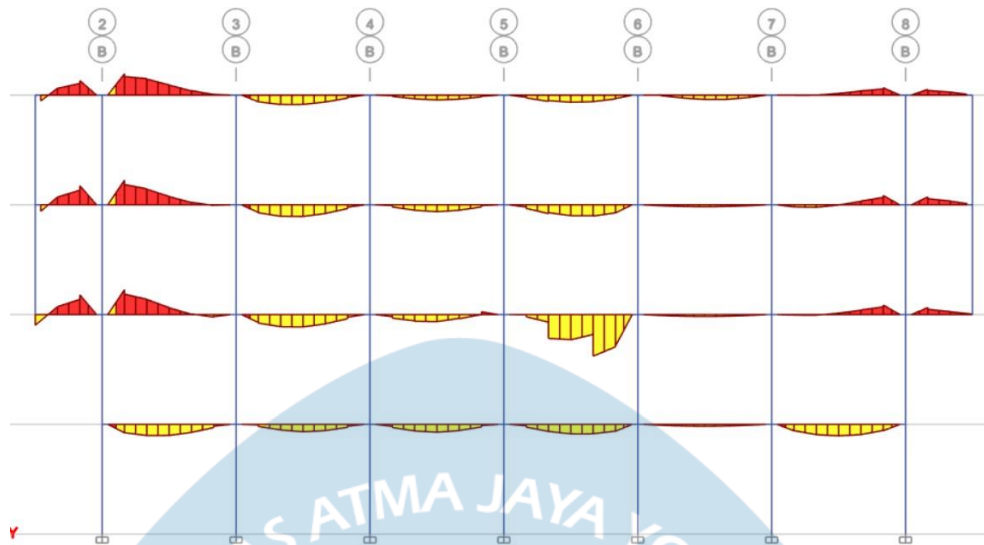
Langkah-Langkah Pemodelan Gedung
